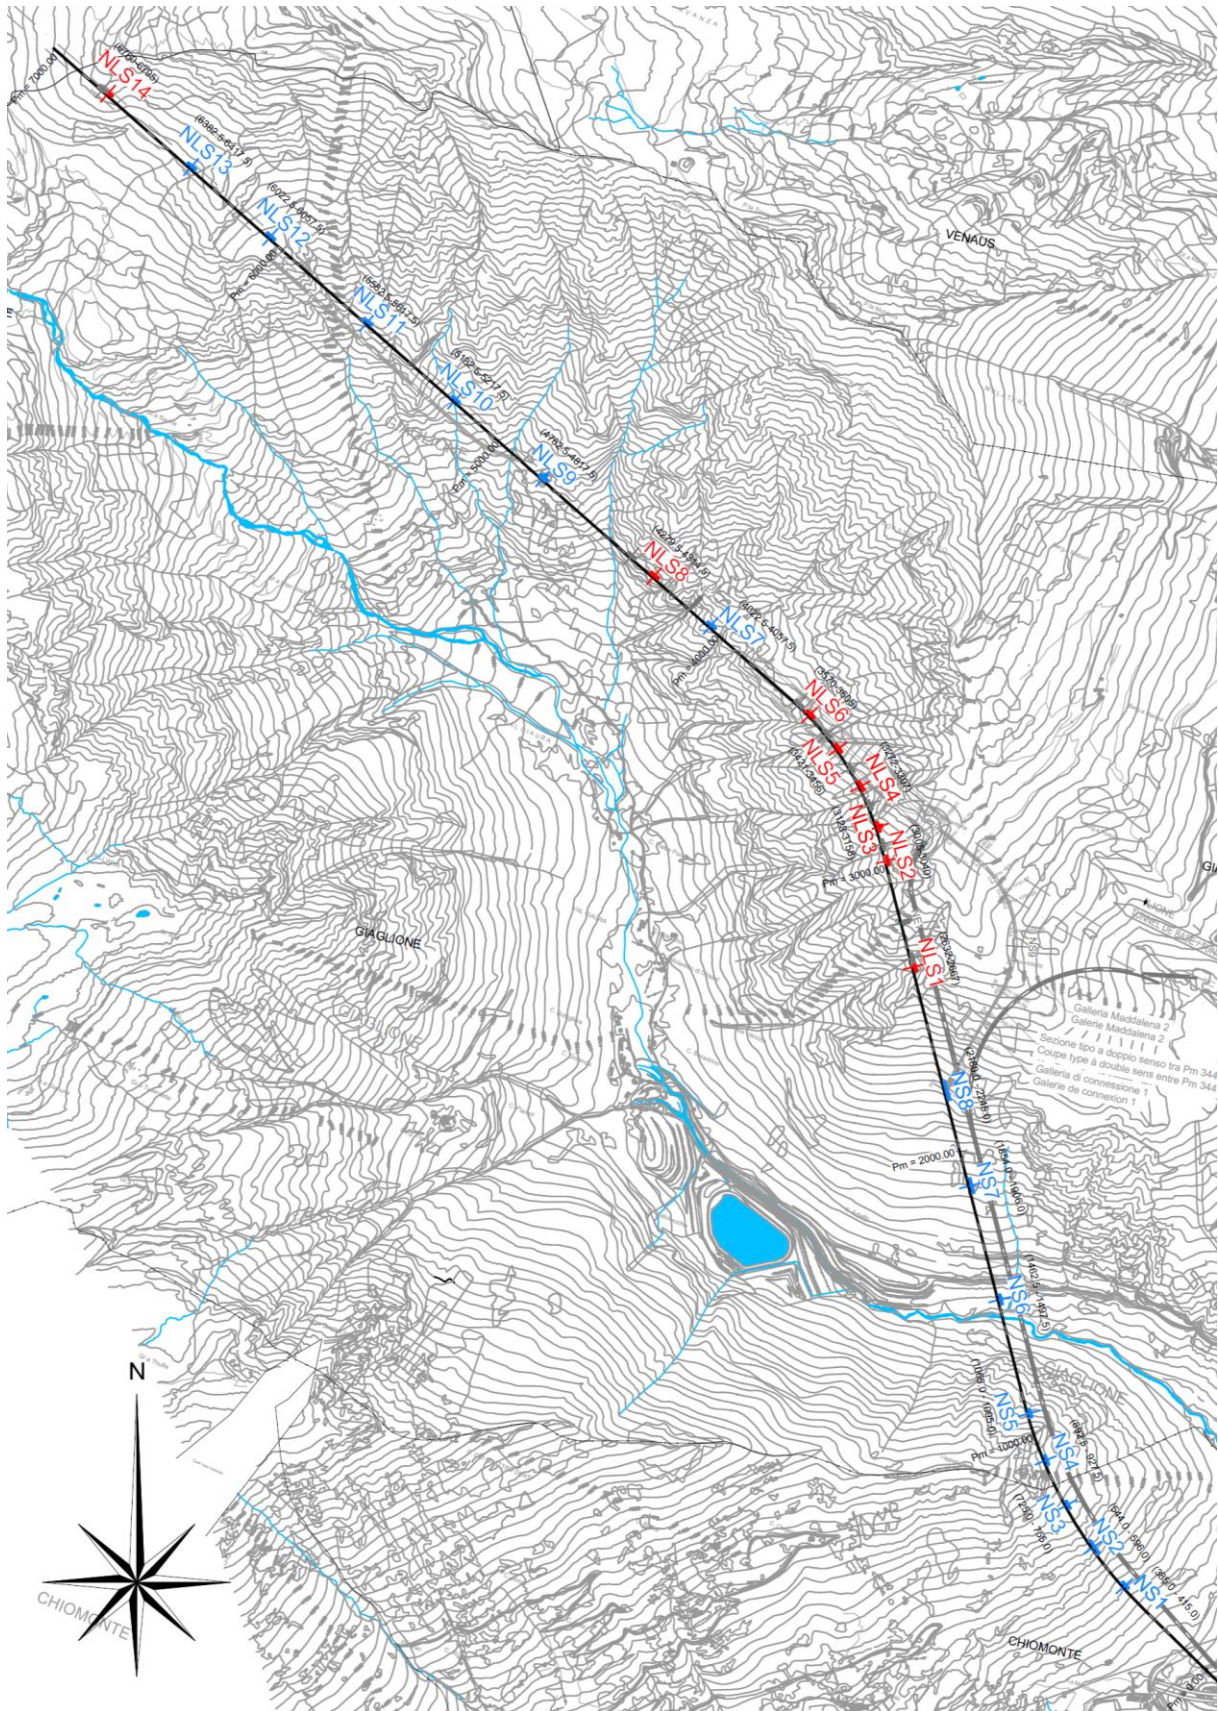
Nicchie – Spostamenti rispetto al PRV
